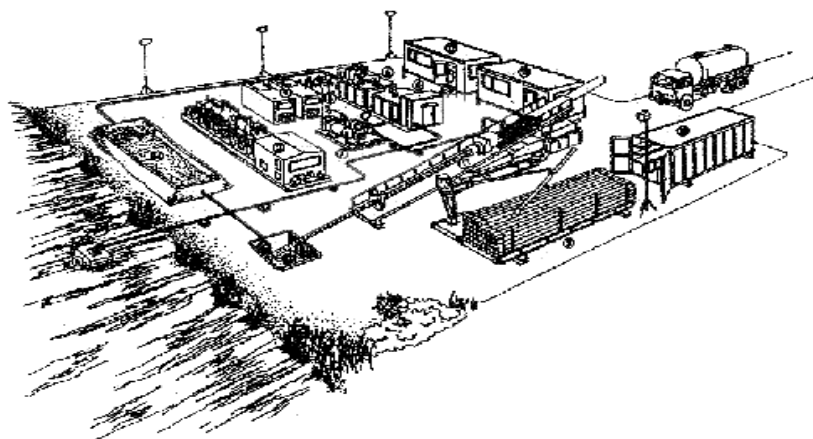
Схема размещения установки ГНБ на строительной площадке:
